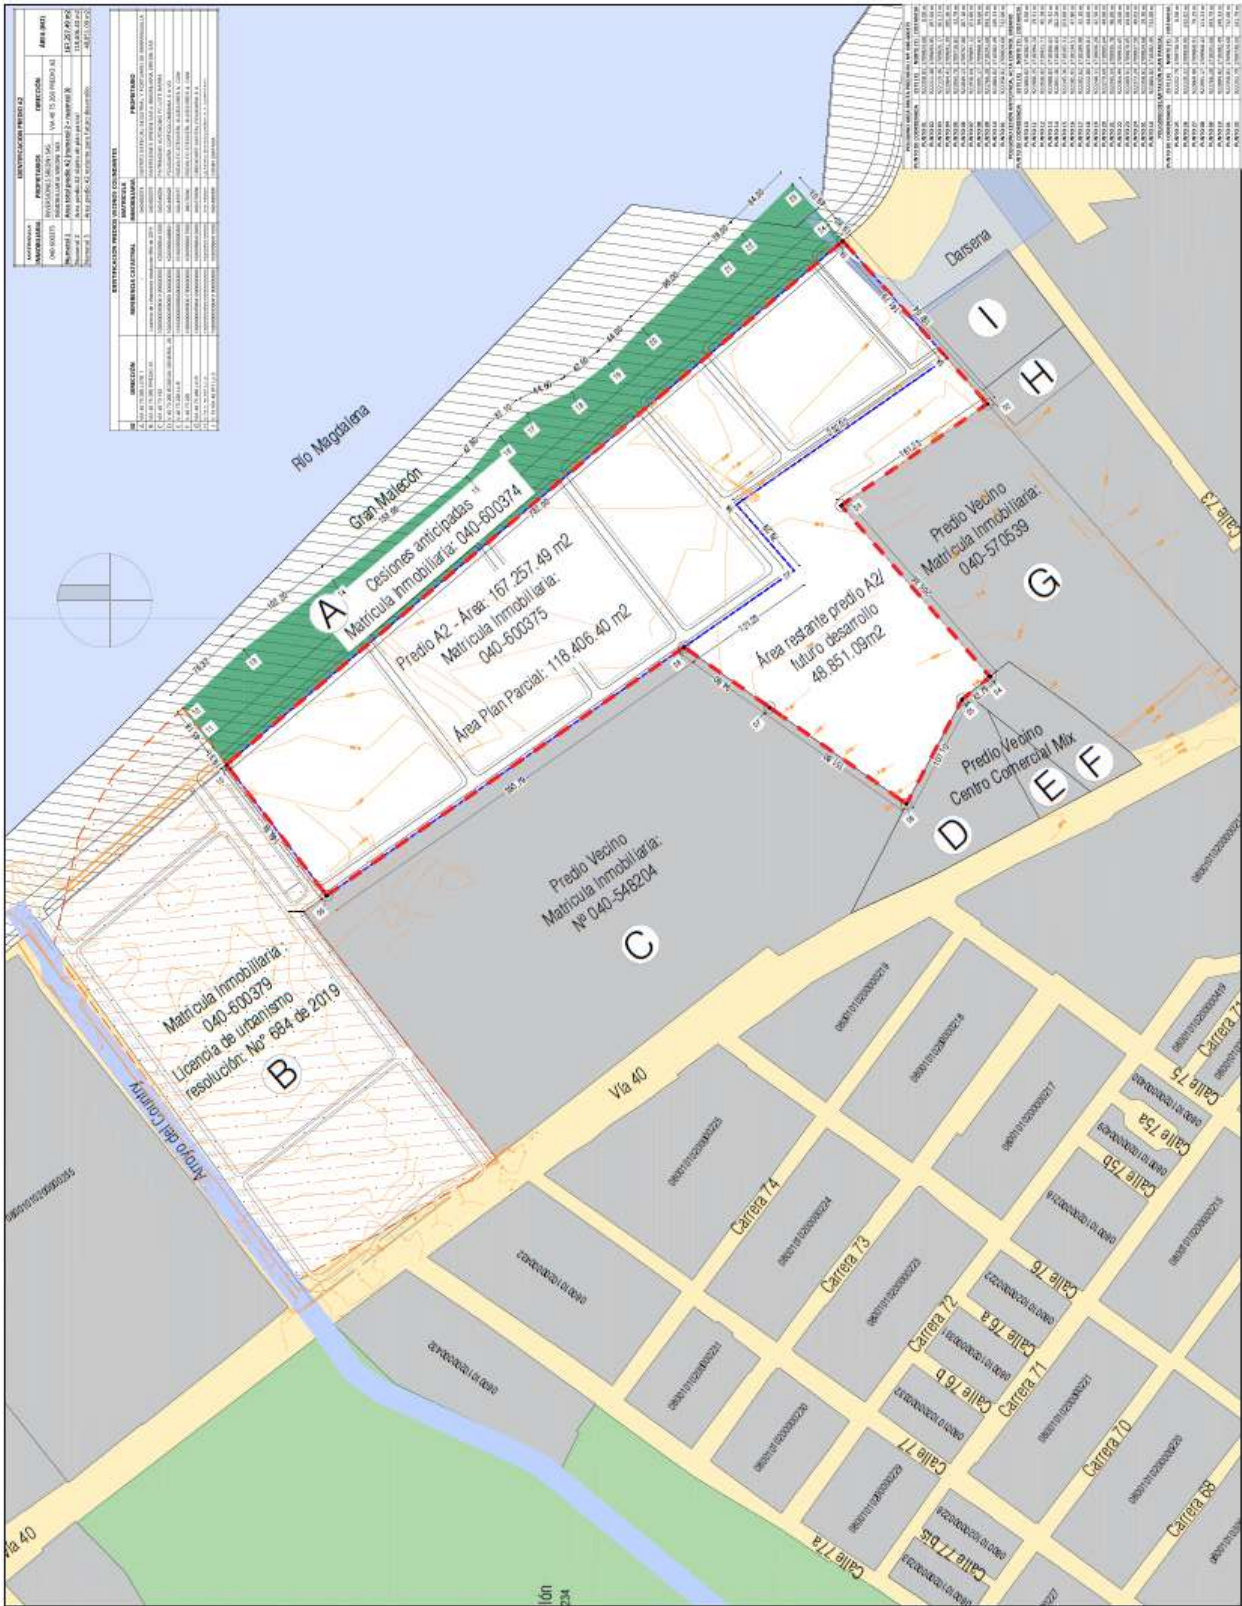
Plano topográfico del área de planificación. Ver plano anexo D-001.
